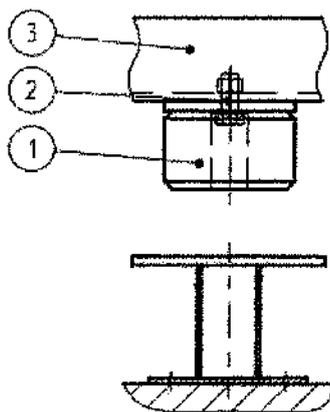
Схема крепления буфера на нижнюю балку противовеса: 1 - буфер полимерный; 2 - болт; 3 - нижняя балка противовеса.
